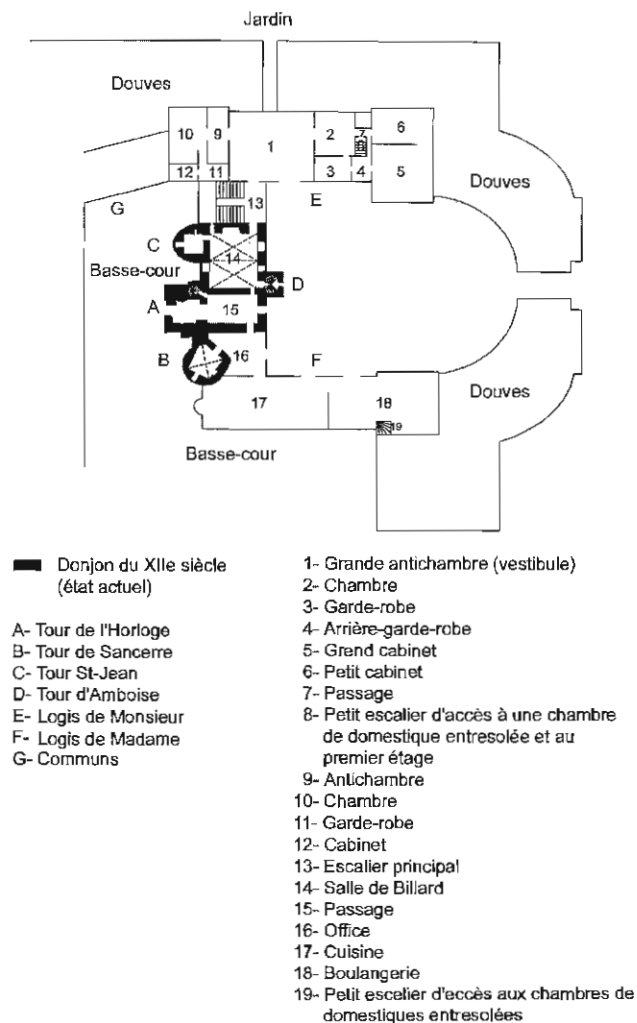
Plan du rez-de-chaussée au XVIII^e siècle (restitution).
